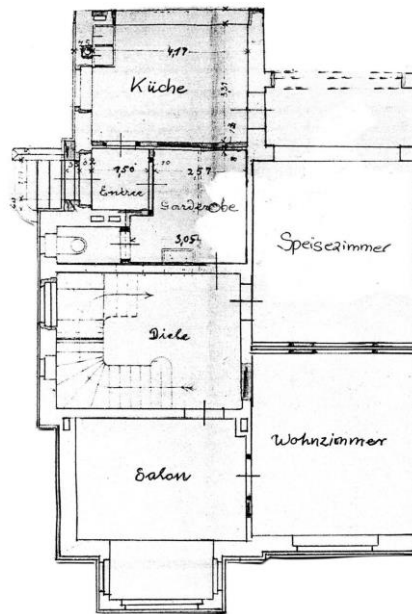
Grundriss Erdgeschoss
